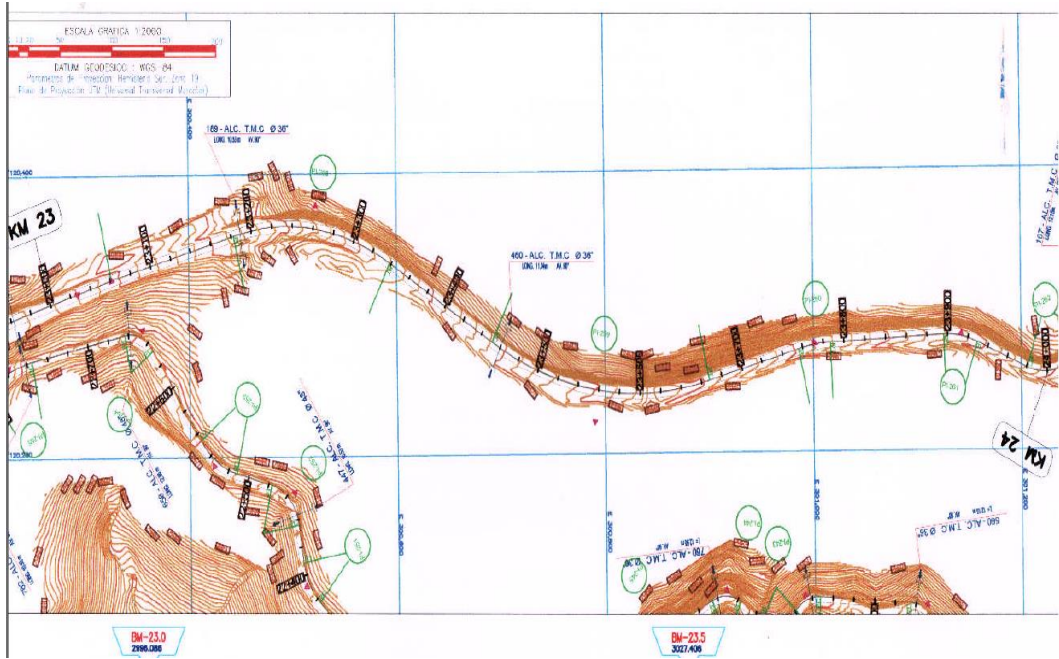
Plano de Planta tramo Km. 23+000 al Km 24+000
